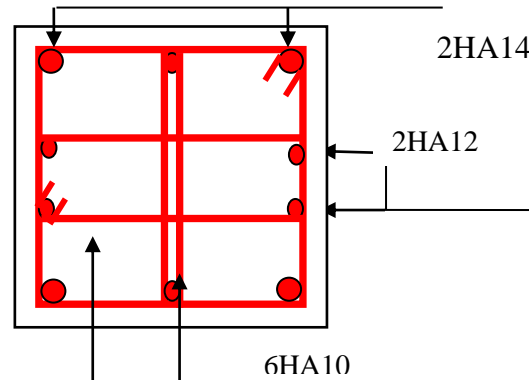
Schéma de ferrailage des Poteaux de 5<sup>eme</sup> ,6<sup>eme</sup> et 7<sup>eme</sup> étage.
